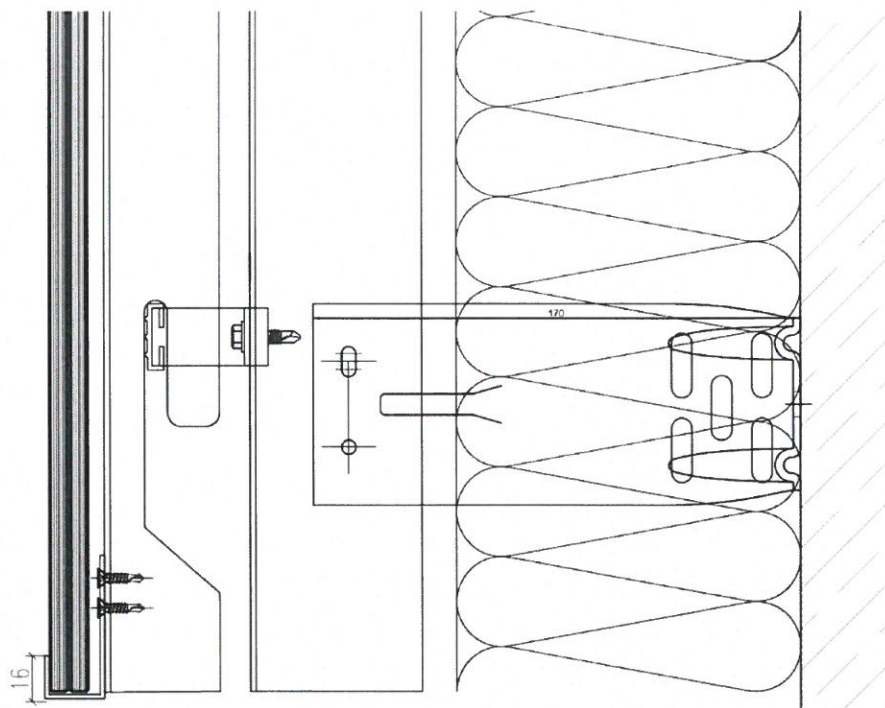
Detale badanych elementów - detal mocowania modułu fotowoltaicznego – ramkowego.
